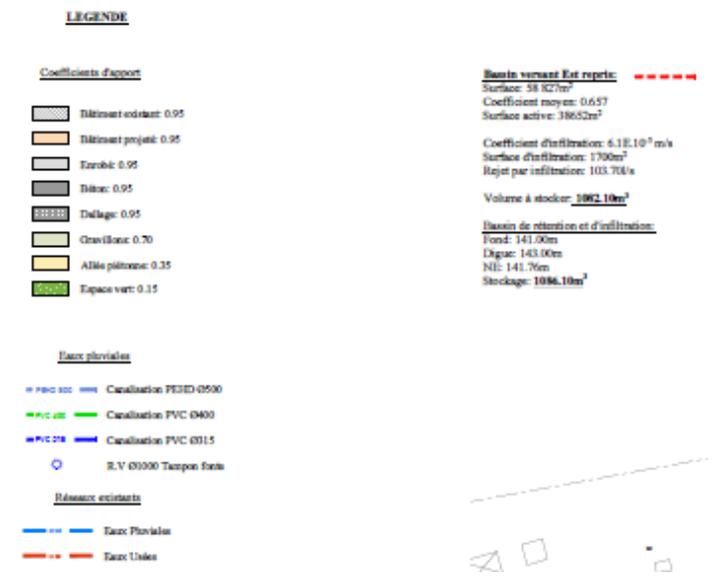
Extrait du plan de gestion des eaux pluviales - Source : Orling
